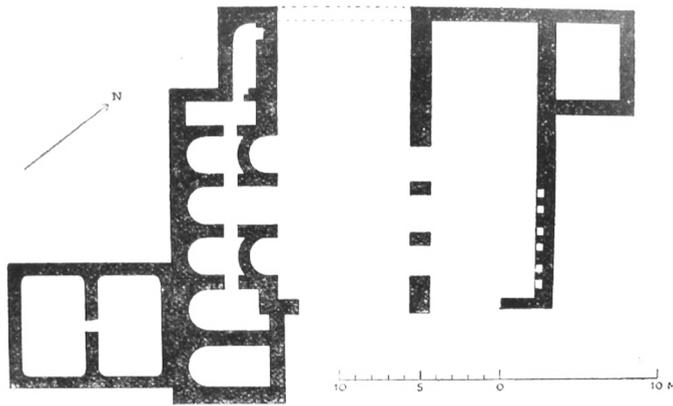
Planta de la edificación excavada por Jules Renault (Lantier, 1921)
